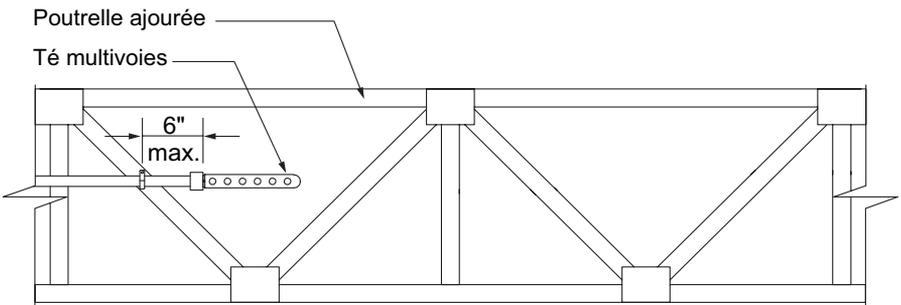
Support de tés multivoies sur des poutrelles de bois ajourées
